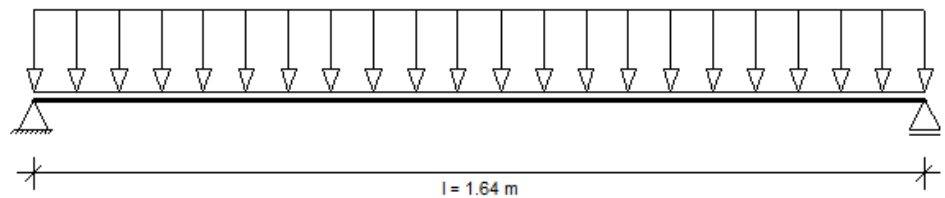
Häufig verwendetes statisches System zur Bemessung der Holzausfachung (BGU, 2016)
